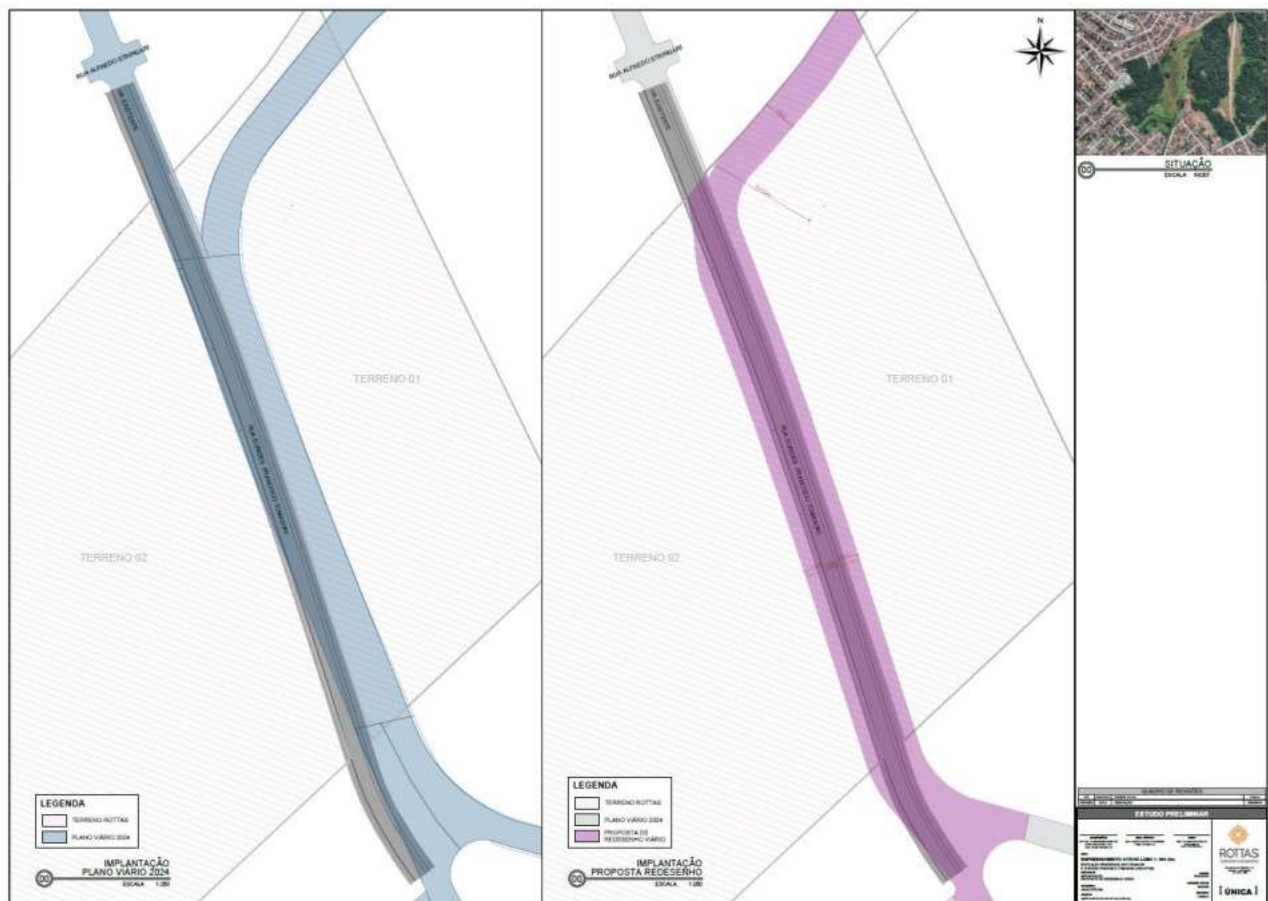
Croqui da proposta de alteração no Plano Viário 2024.
